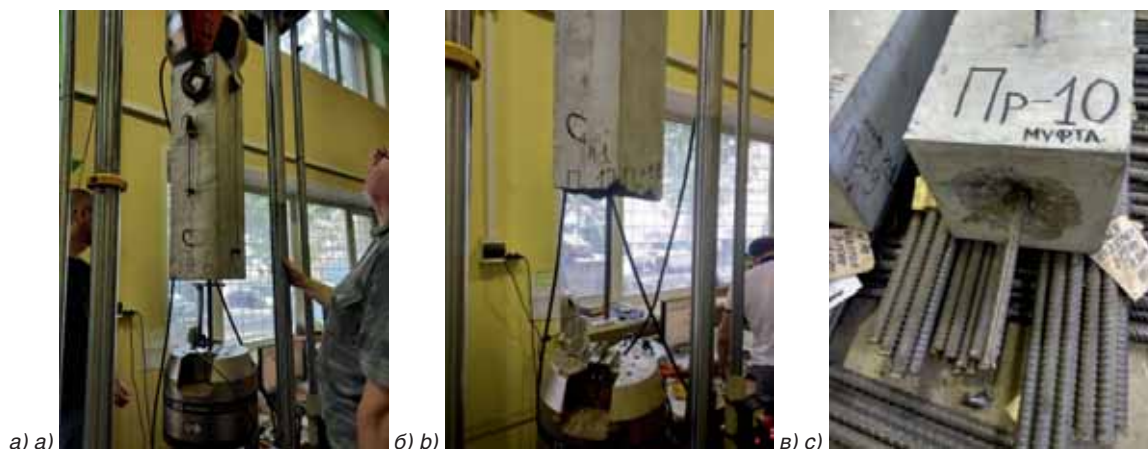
Растяжение арматуры, забетонированной в центре призмы:
